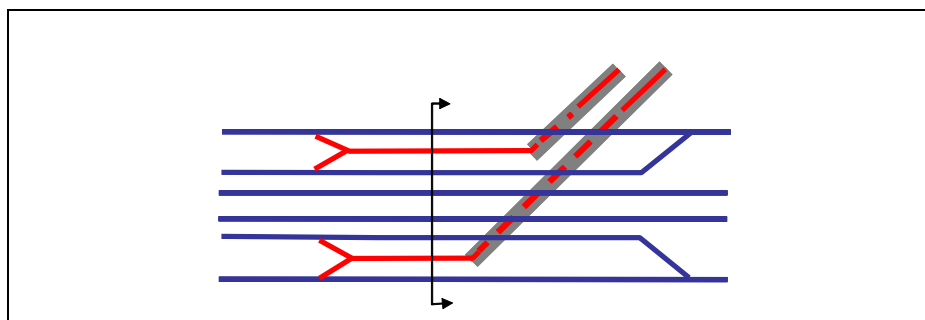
Tunnel med täckt station, 1100 m lång tunnel inklusive station i Sundbyberg.
